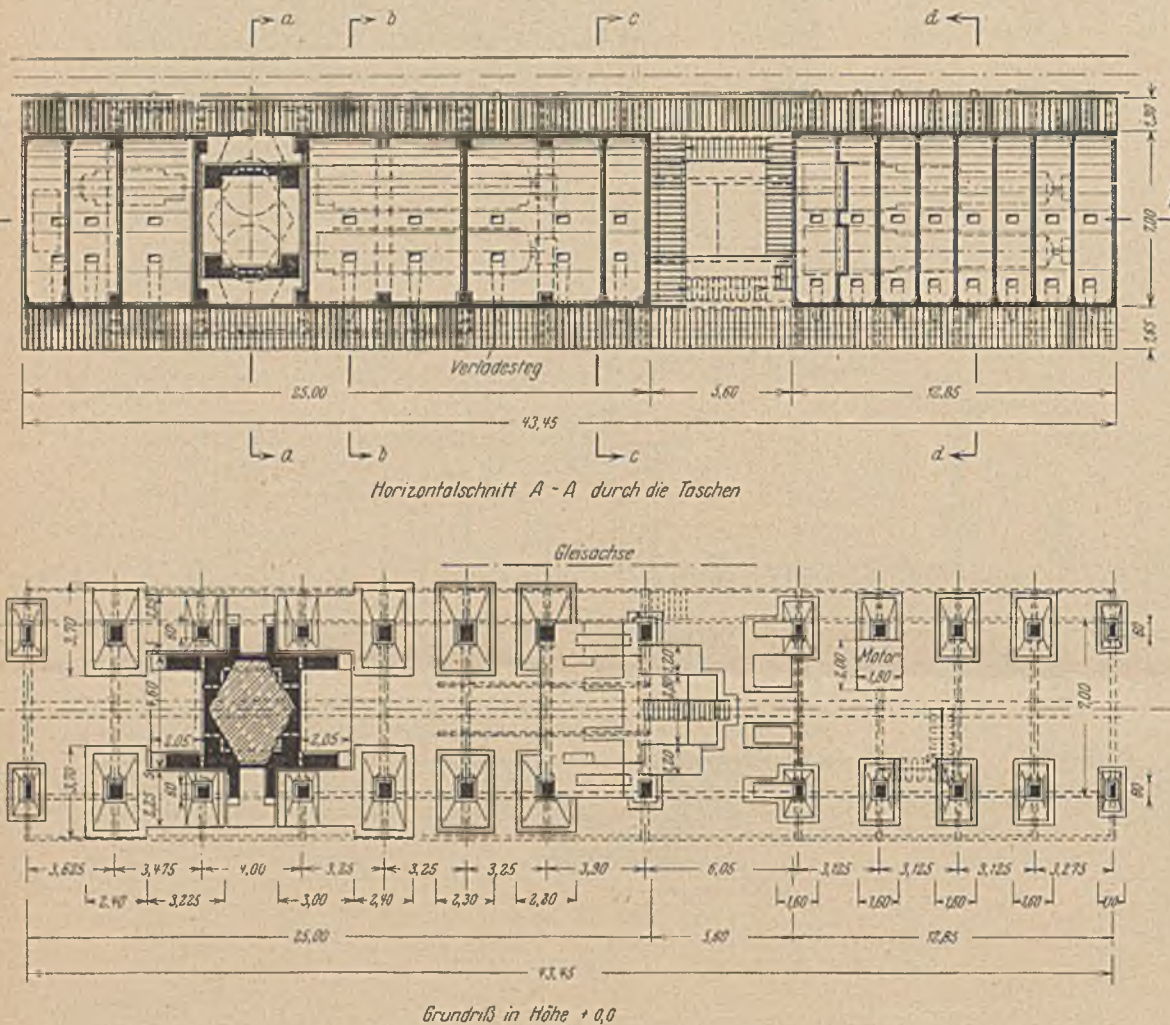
Grundriß und Horizontalschnitt (siehe Abb. 7).
